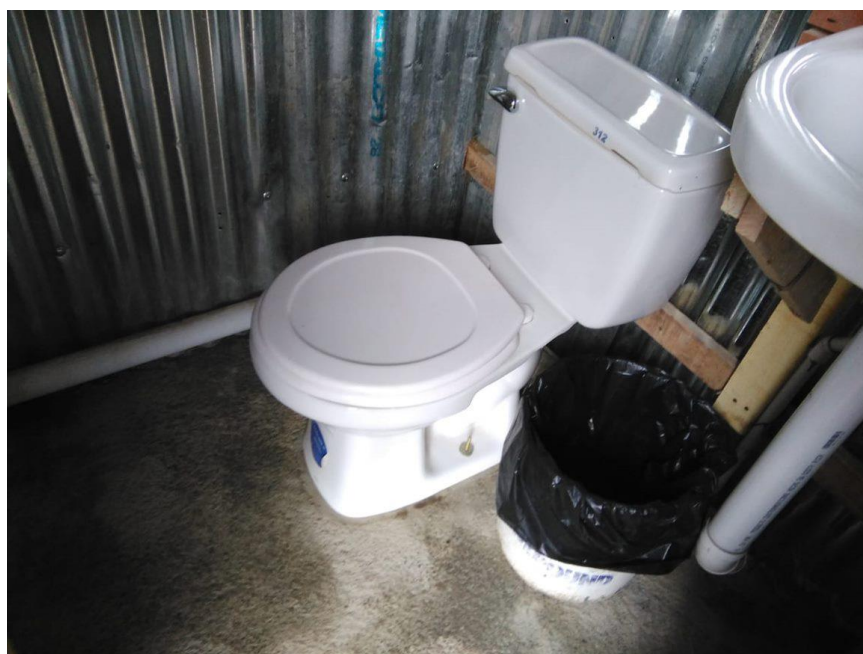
Inodoro de bajo consumo instalado en el proyecto Torre Las Loras
